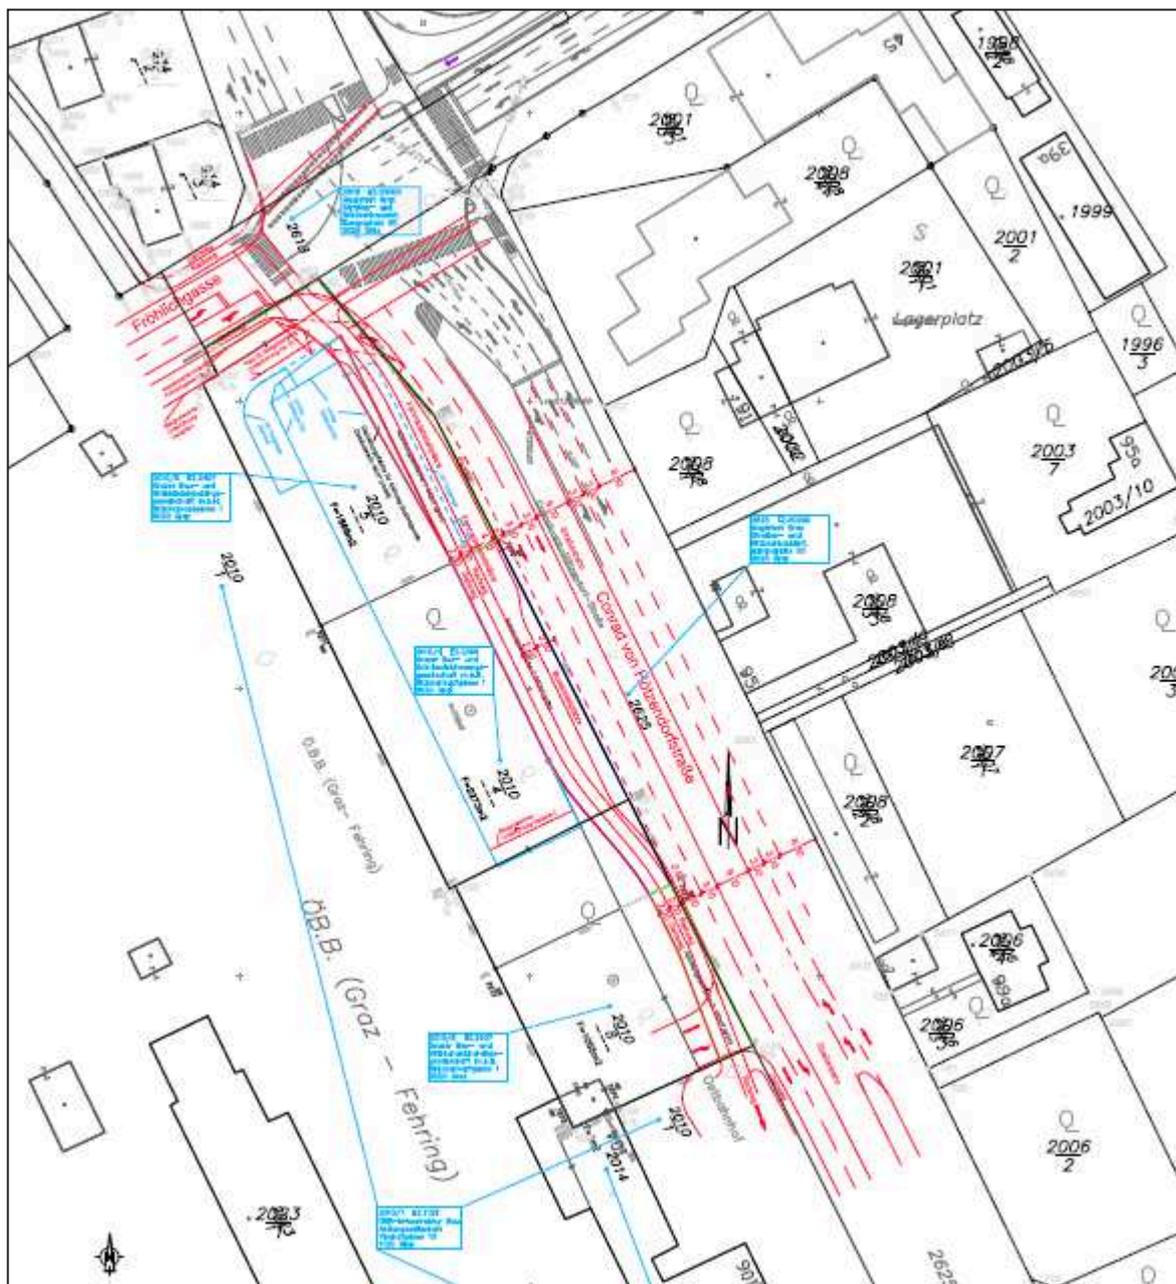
Lageplan – Infrastrukturausbau „Ostbahnhouse“ (siehe Planbeilage B)
